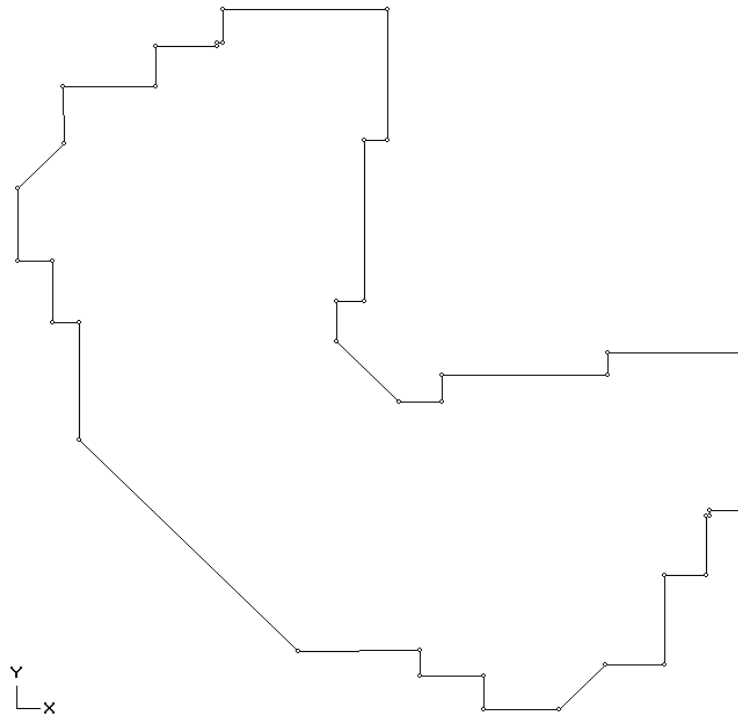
Опалубкове креслення фундаментної плити ФП 1
